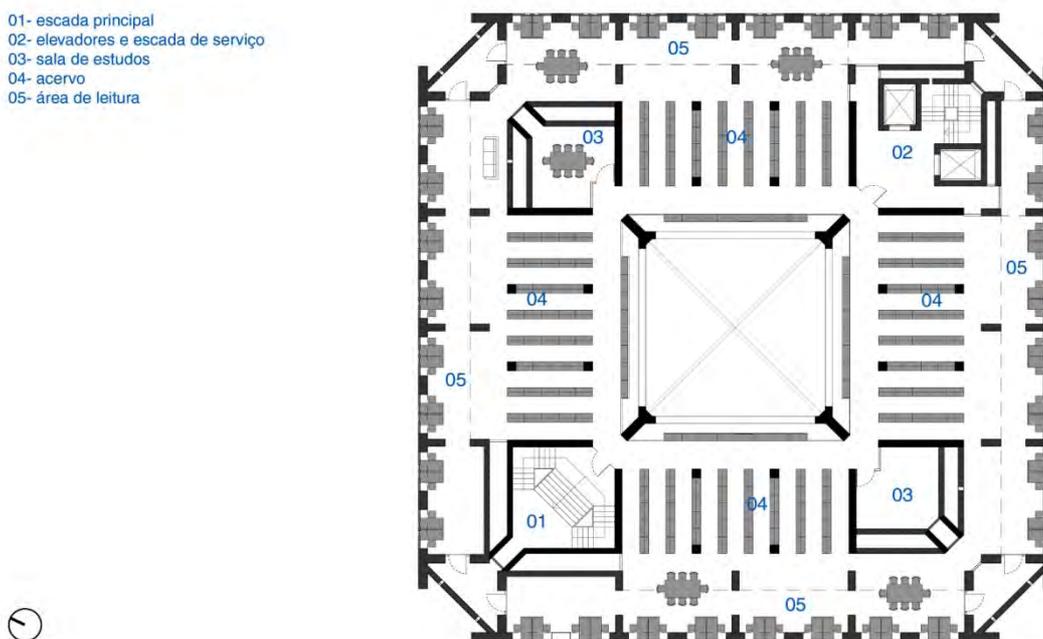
| Planta da biblioteca de Exeter [redesenho do autor]
